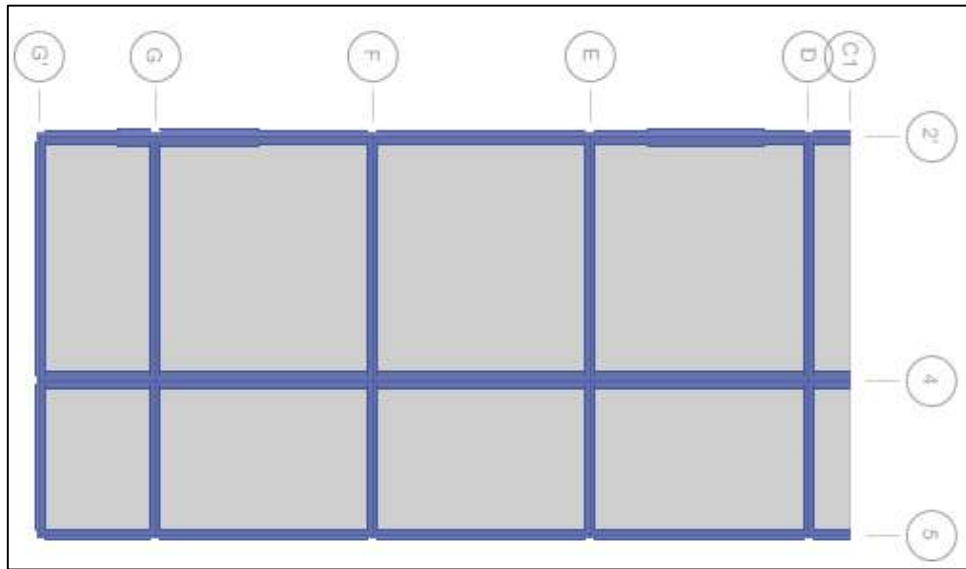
Planta N+2.70 Estructura 2.2 CENIGRAF
